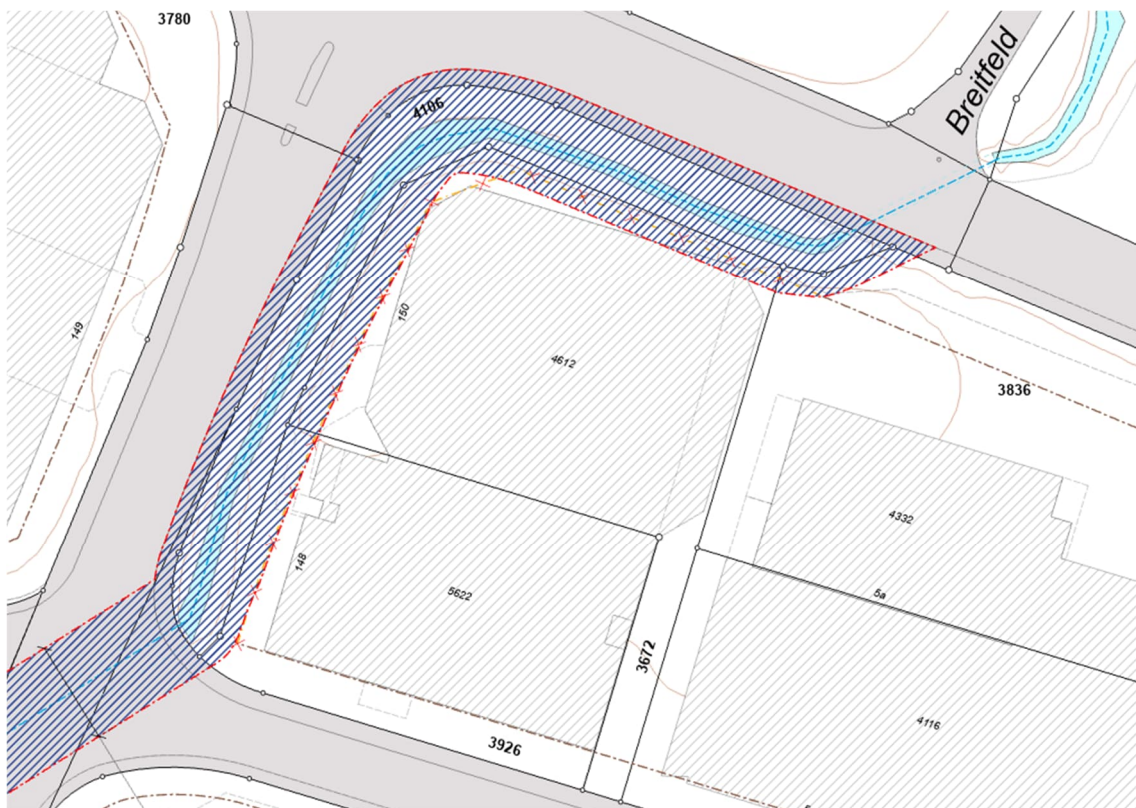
Ausschnitt Aufhebung Baulinie Verkehr des Überbauungsplans mit besonderen Vorschriften Industriestr./Schlachthofstr. Plan-Nr. 4
